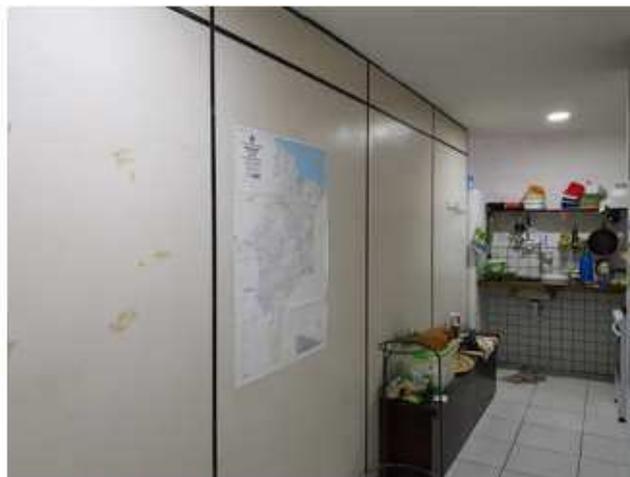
Vista da parte posterior da divisória em PVC, na cozinha da unidade nº 8.
